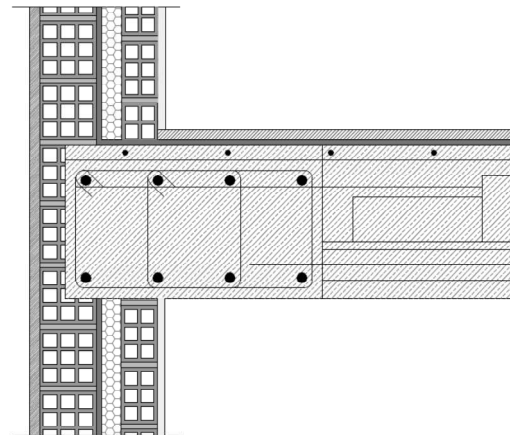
Fachada-Forjado. Zona este. Estado rehabilitado.
